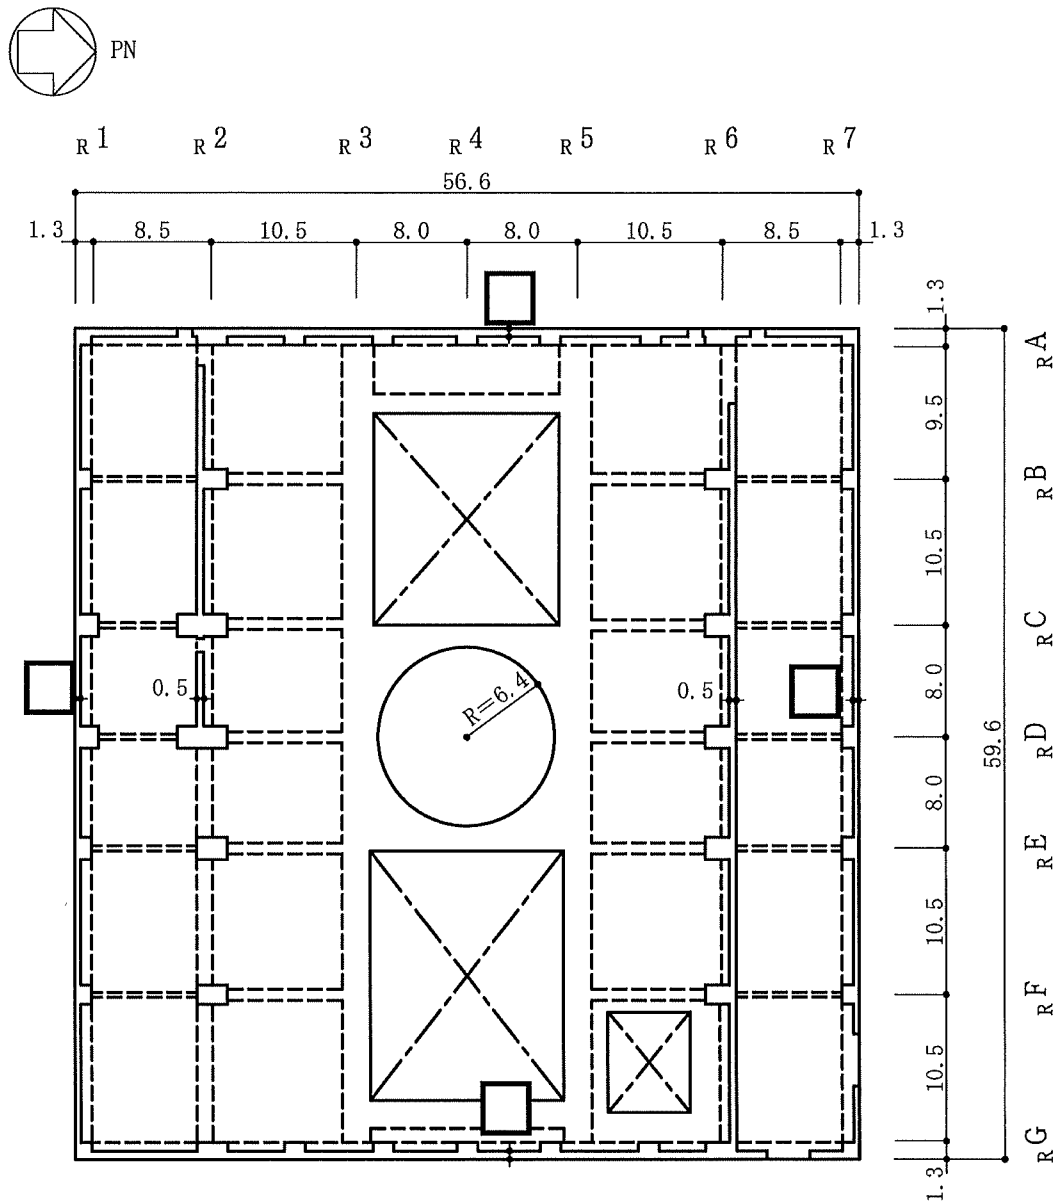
原子炉建屋の概略平面図 (4F, T.M.S.L. 31.7m) (7/9) (単位 : m)
